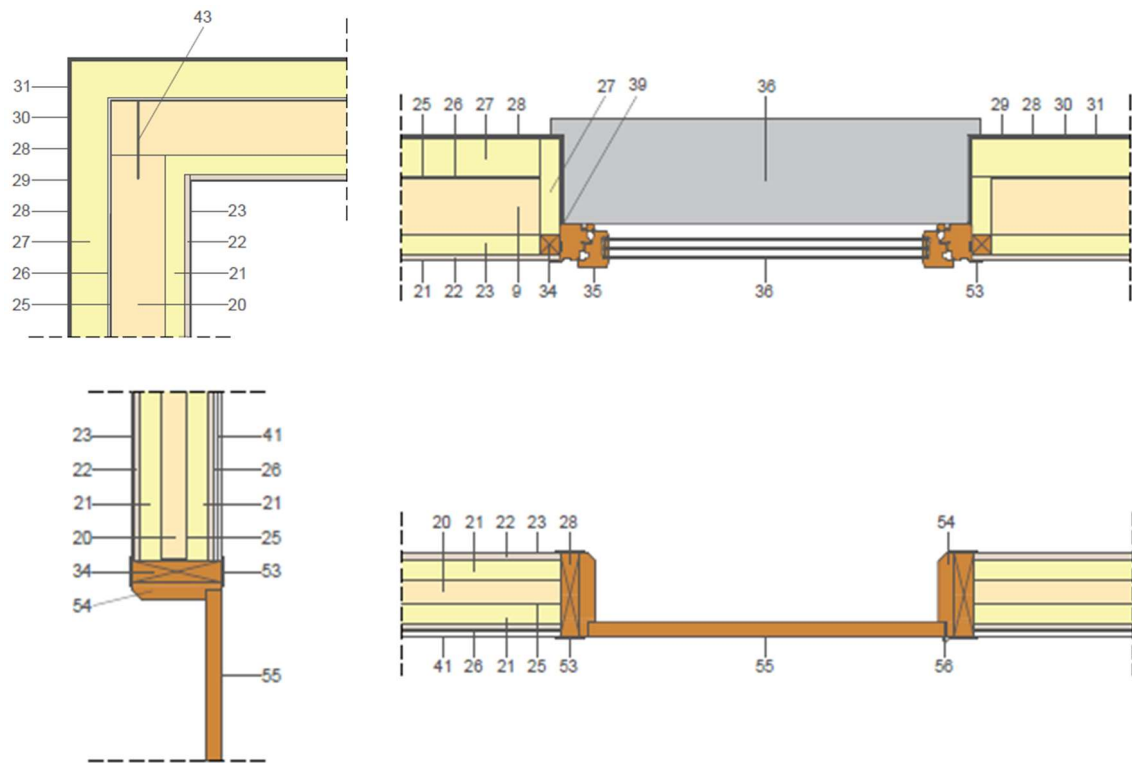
Sección constructiva encuentros. 2025. Fuente: Elaboración propia
